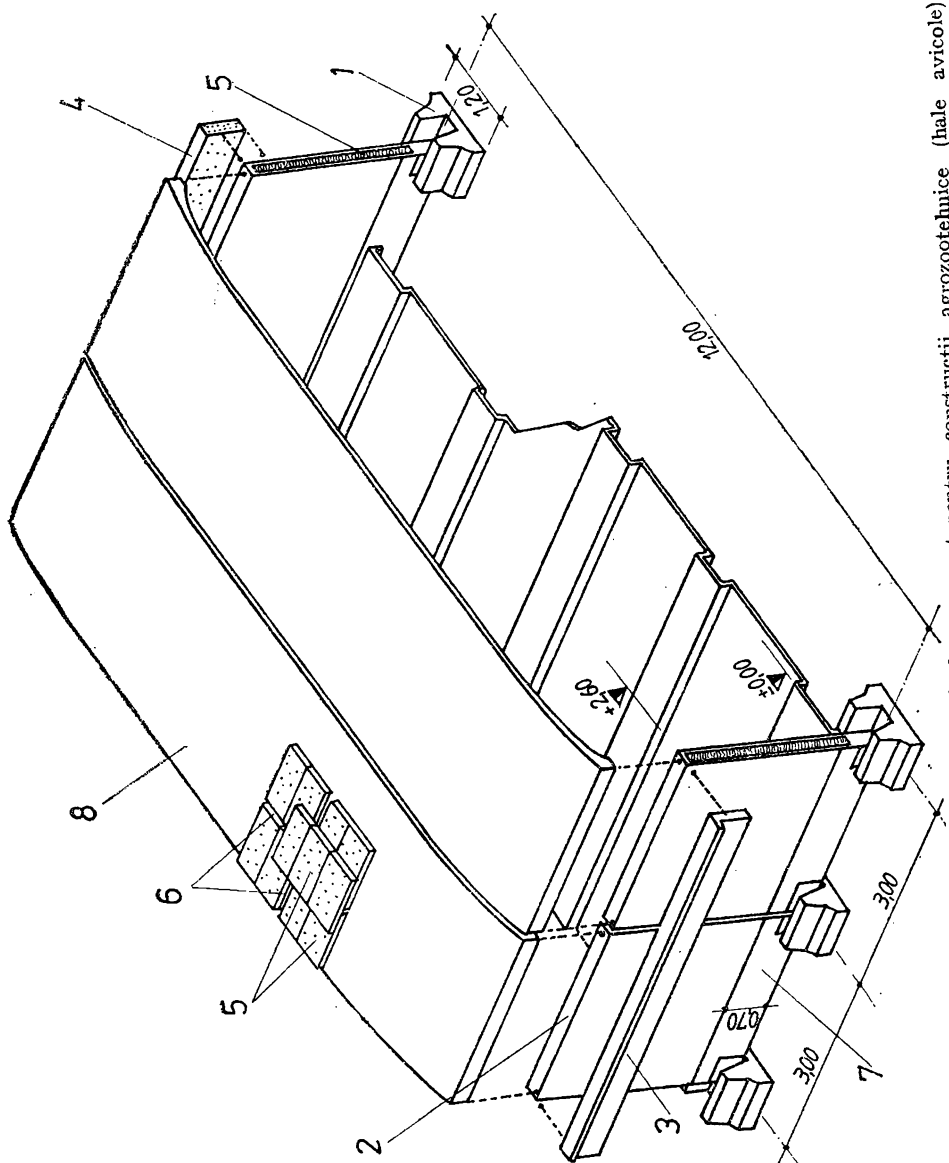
Structură integral prefabricată din beton armat pentru construcții agrozootehnice (hale avicole); 1 — fundație pahar; 2 — panou portant de perete cu termoizolație inclusă; 3 — element de atic în varianta 1 — element de atic în varianta cu panou BC4 0, 60 x 6,00 m; 4 — element de atic în varianta cu panou BC4 0, 60 x 6,00 m; 5 — ter-din panou de beton armat 0,60 x 6,00 m; 6 — element de acoperiș 3,00 x 12,00 mu.; 7 — element de acoperiș 3,00 x 12,00 mu.; 8 — element de acoperiș 3,00 x 12,00 mu.
